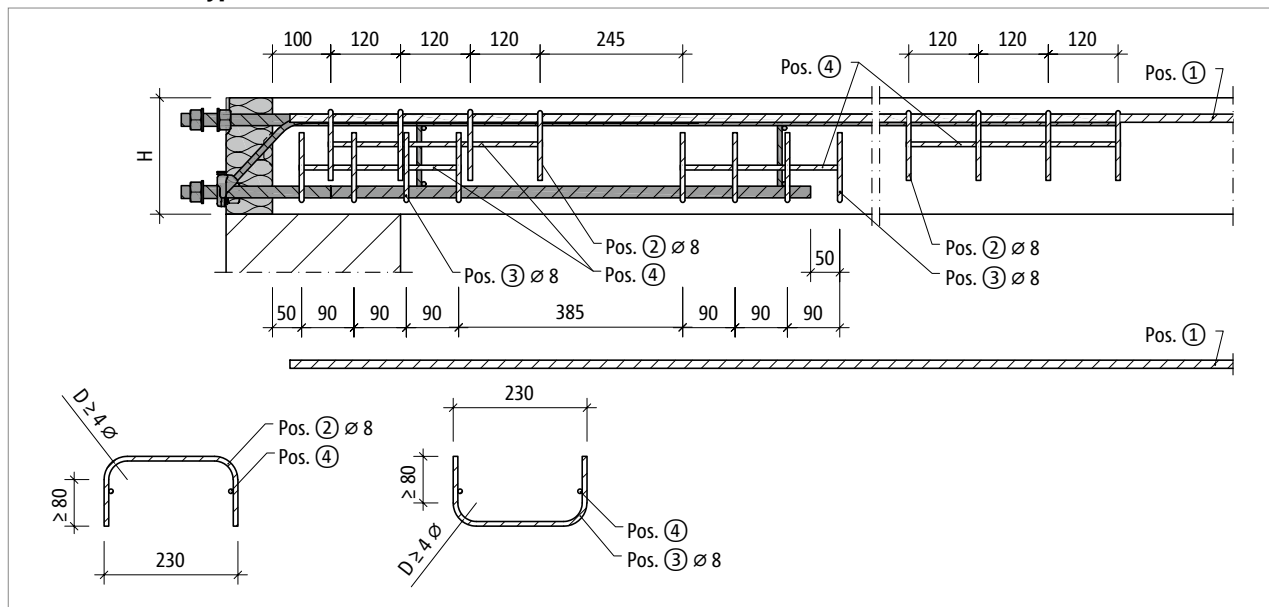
Schöck Isokorb® T type SK-MM2 : renforcement sur site avec étriers $\varnothing 8$ mm ; coupe
